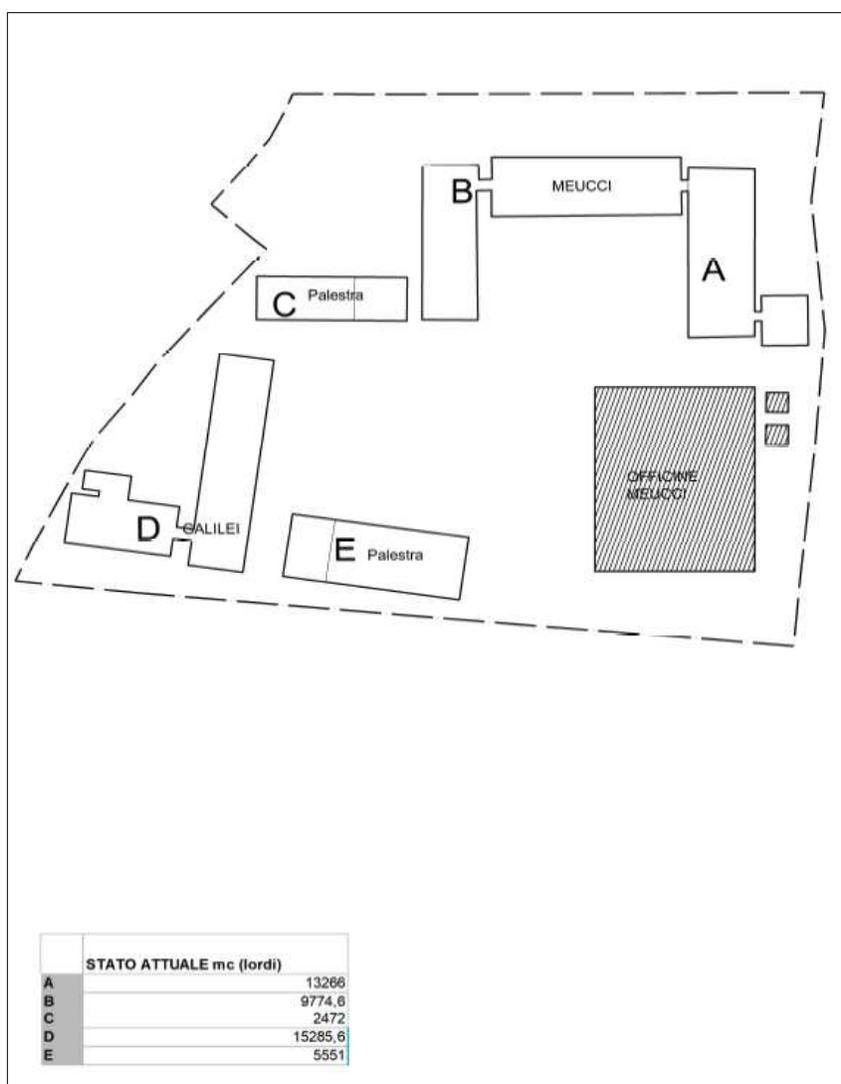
Schema stato attuale con individuazione edifici da demolire
